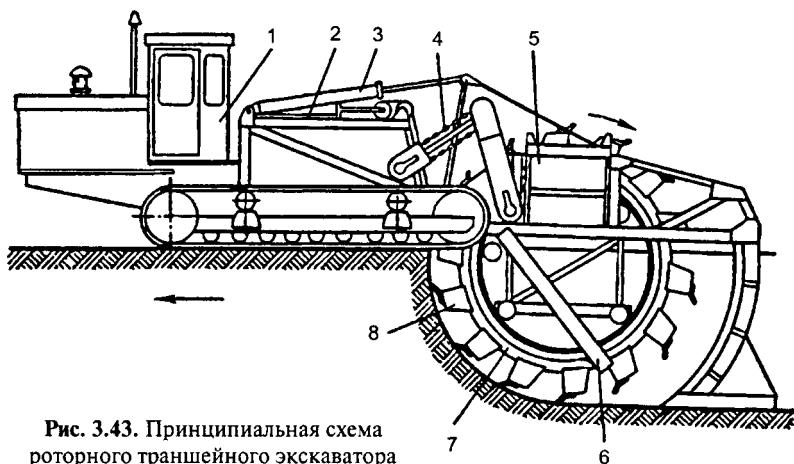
Принципиальная схема роторного траншейного экскаватора
